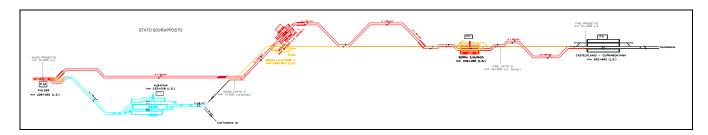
Layout della configurazione di progetto (stato sovrapposto)
